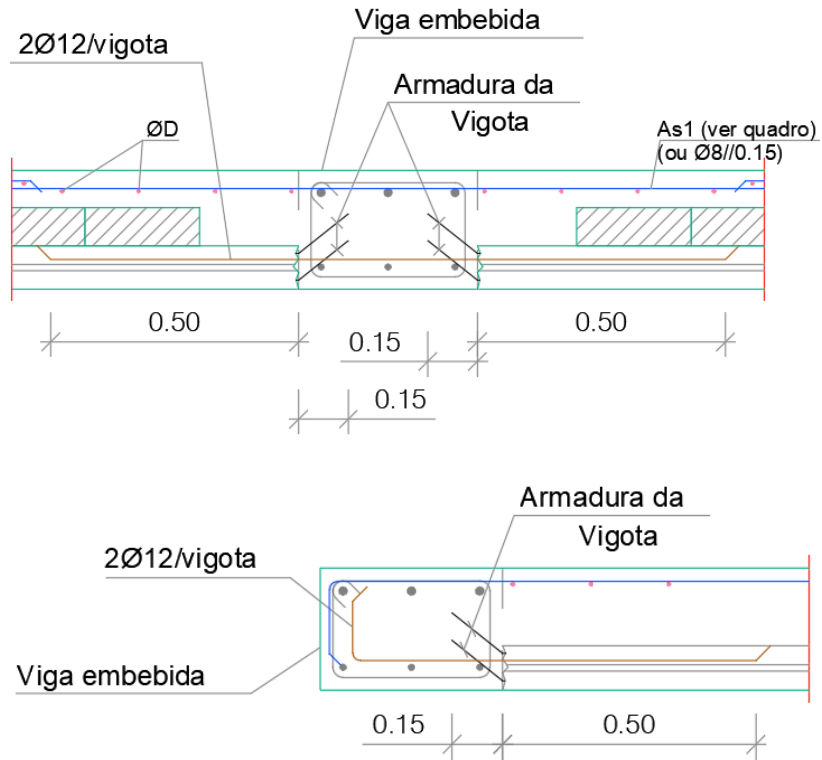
Pormenor tipo de ligação das lajes aligeiradas às vigas embecidas (Projeto de estruturas).
